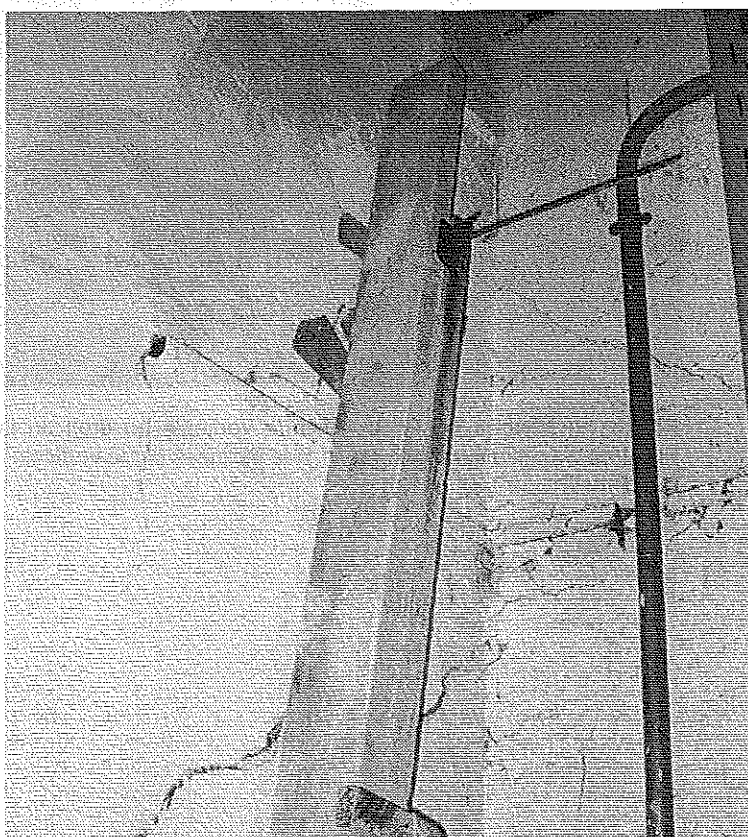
Angle pignon-façade. Vue intérieure. Fissure + étaielement.
